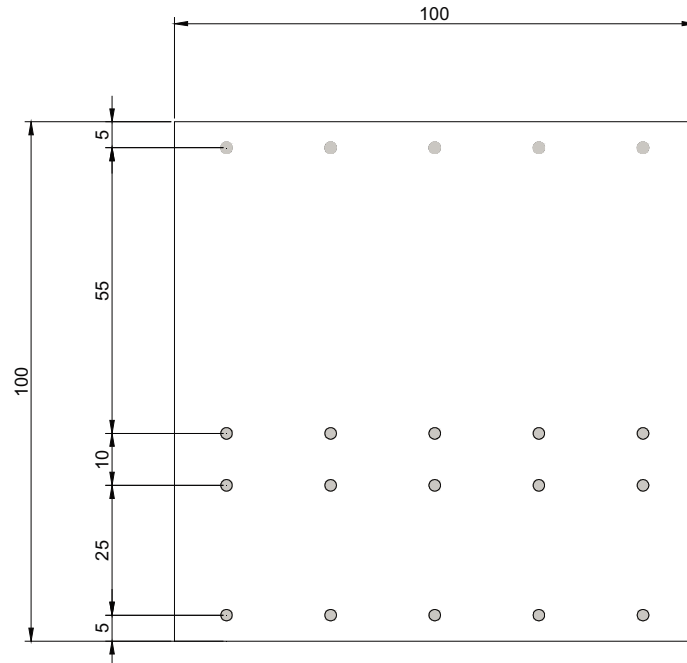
Sezione di contatto Muro in spessore - Fondazione
